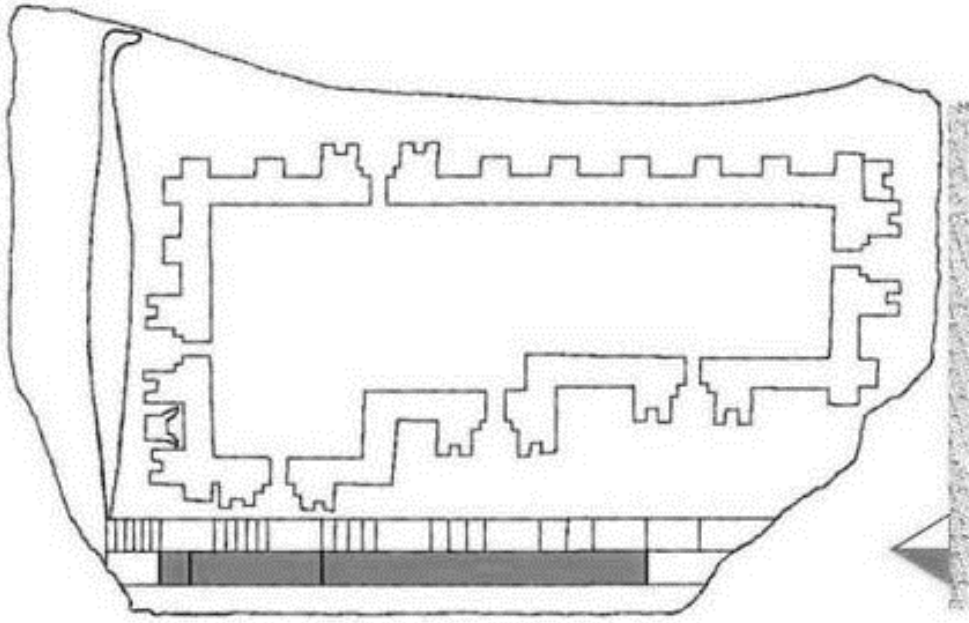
Tablero y escalímetro en la escultura: "*Gudea, el arquitecto del plano*"
